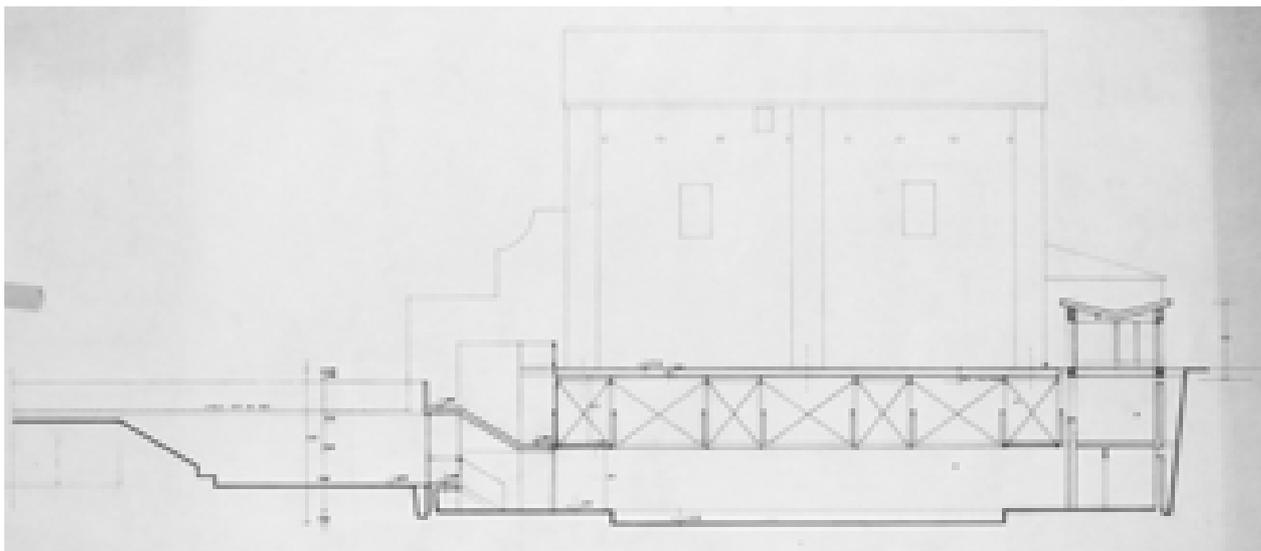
Sezione XX – stato futuro - s.d. (AABS-95.222)
